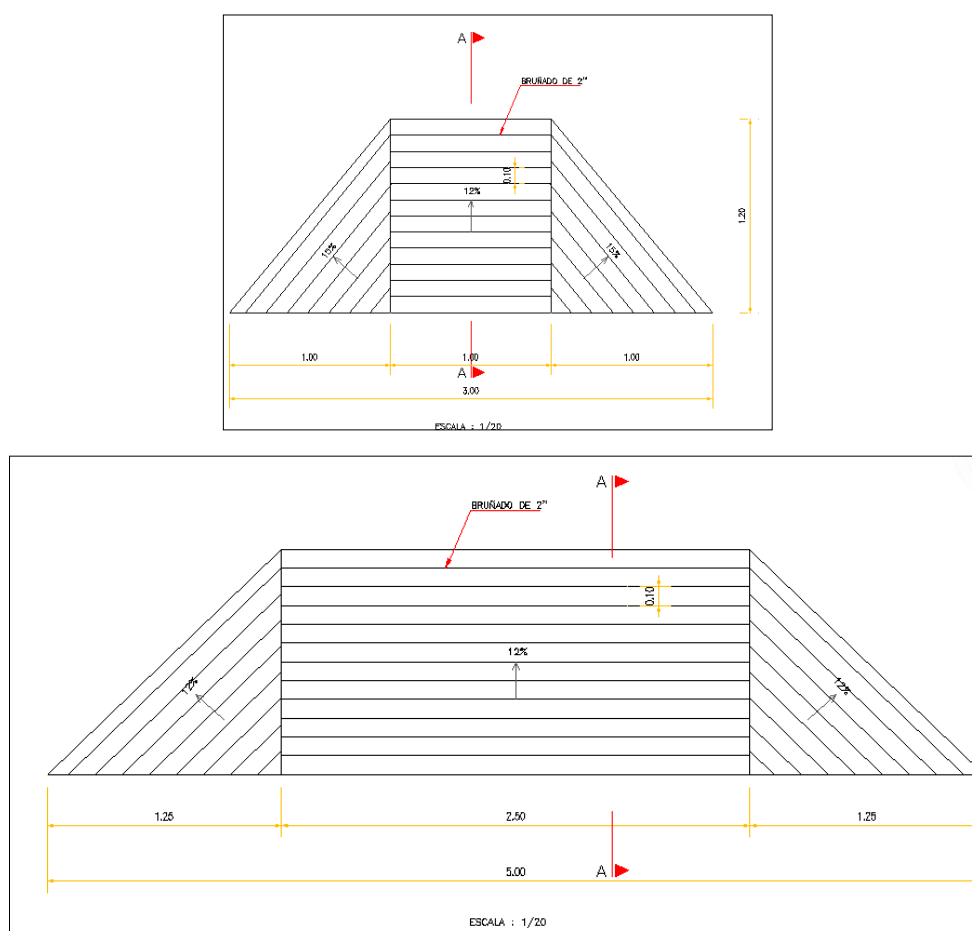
Detalle de rampas peatonales de tipo transversal.
